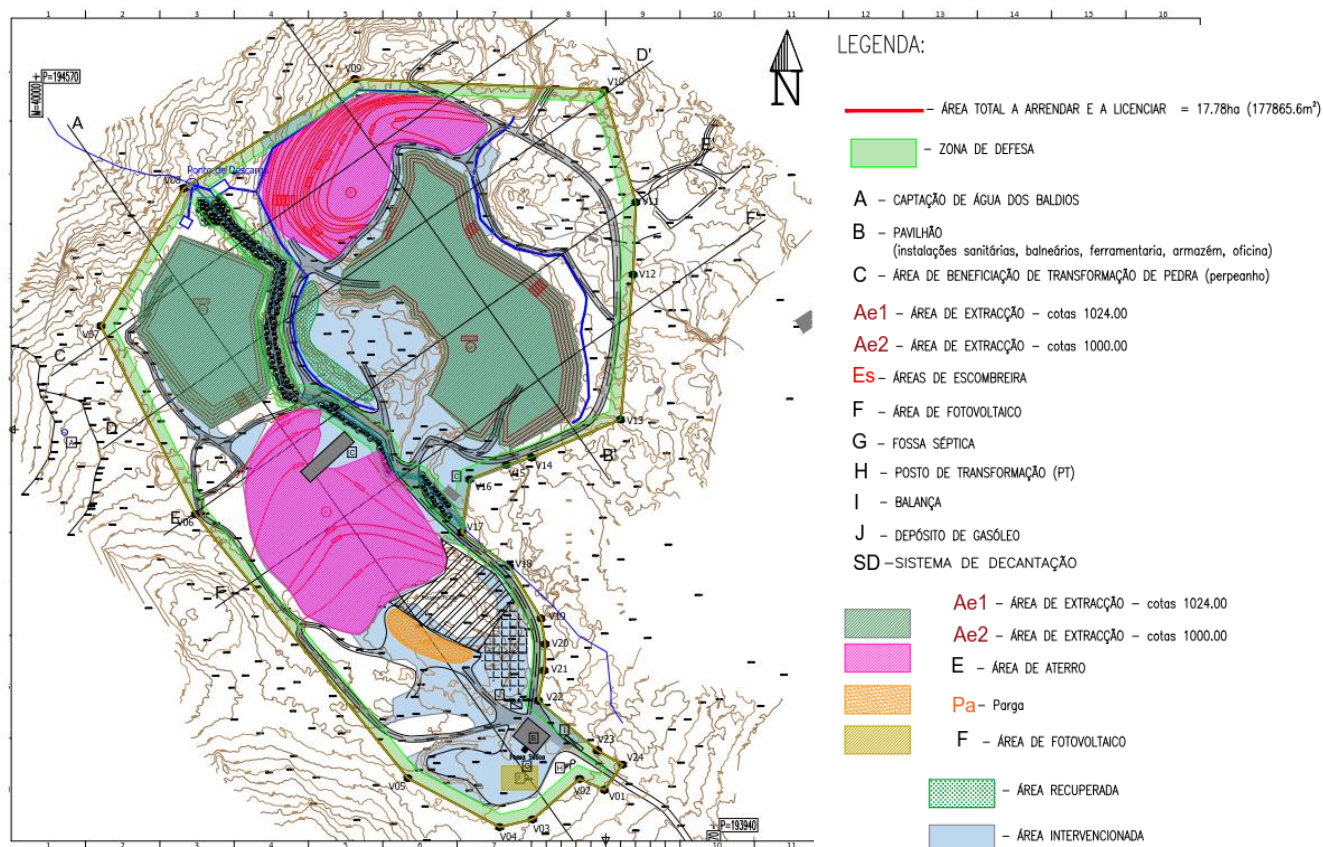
Zonamento proposto (s/escala) (Ver também planta anexa).
